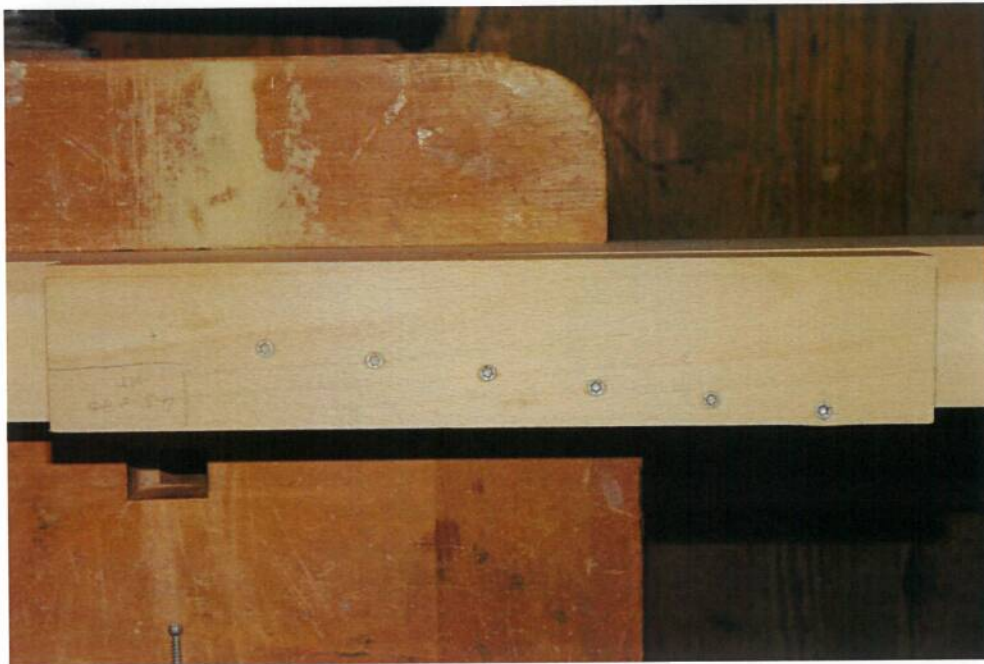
Situation 3 - Verschraubung mit Doppelgewindeschraube WT-T 4,5x70mm
